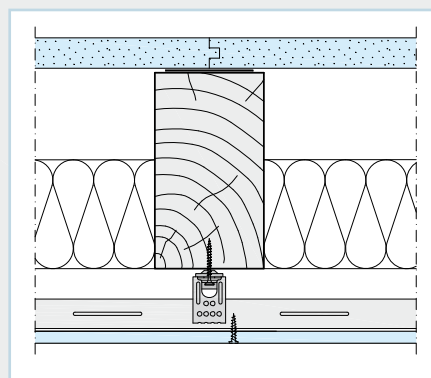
Holzbalkendecke mit Unterdecke und GIFAfloor Freitragendes System
